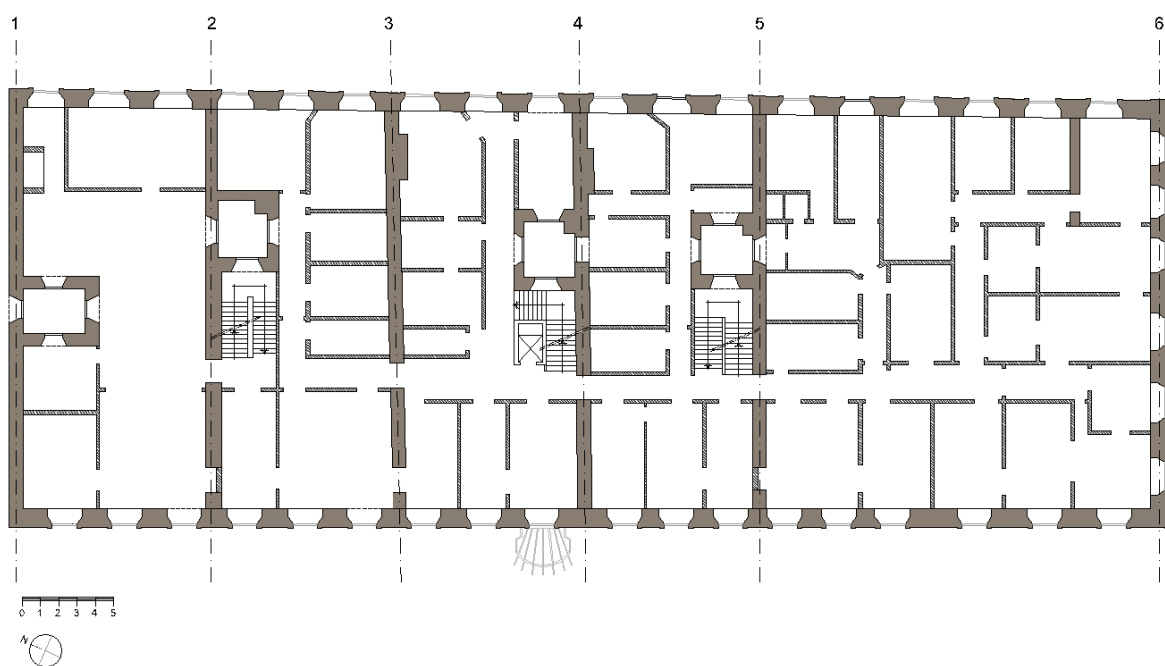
Planta do Piso 3 – (Levantamento do Existente)
